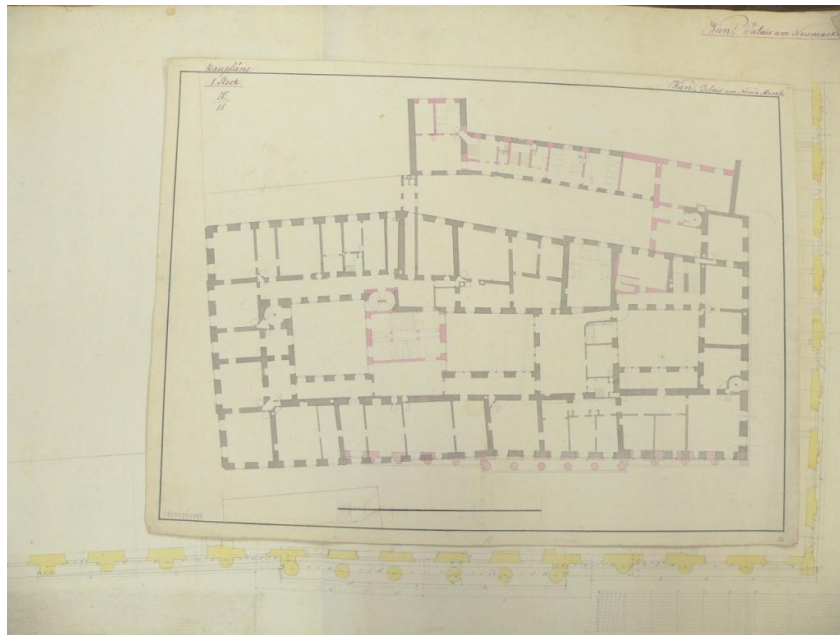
Ehemaliges Stadtpalais Schwarzenberg, Baupläne 1. Stock IV 13 über Baupläne *Facaden* X 1 Belegrixy Grundriss(Vgl. Abb. 59 - beide SOA).
